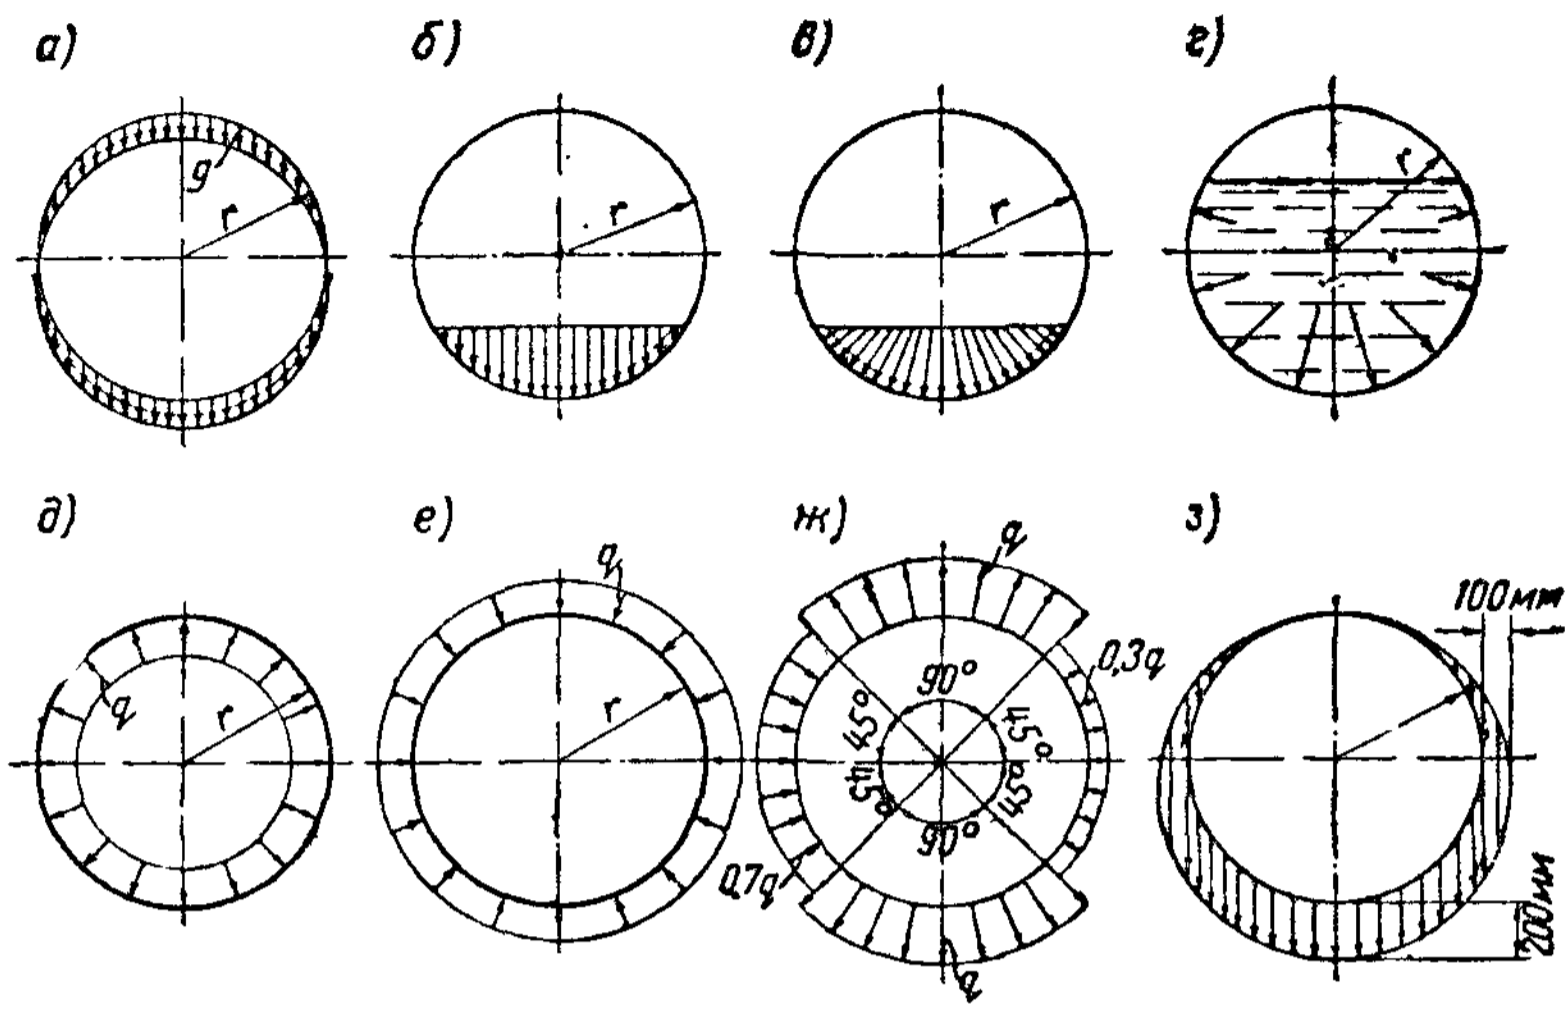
Поперечные нагрузки, действующие на надземный трубопровод, лежащий на отдельных опорах
